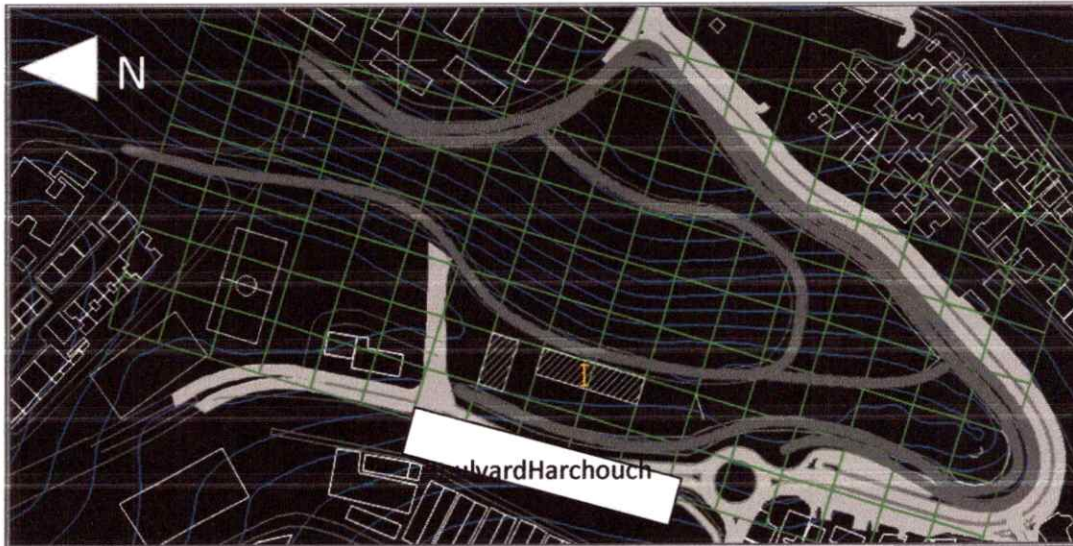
plan du site et emplacement du premier bâtiment « I »
